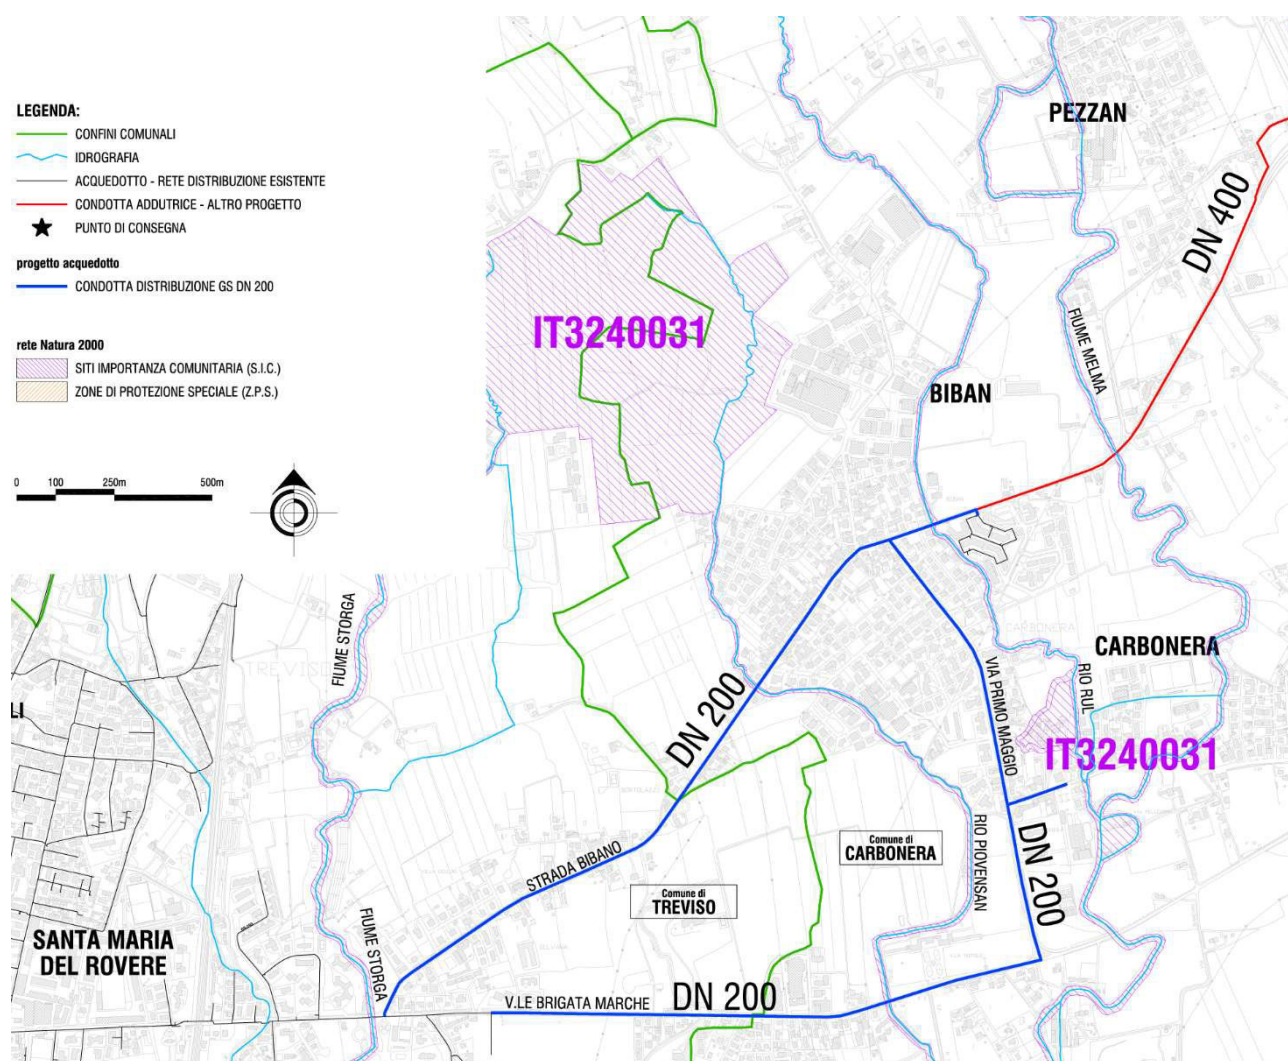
Planimetria delle opere di progetto e delle aree SIC-ZPS: la nuova rete di distribuzione attraversa le aree SIC dei corsi d'acqua Rio Piovensan e Rio Rul, la futura rete di adduzione verso Salettuol attraversa l'area SIC del Fiume Melma
